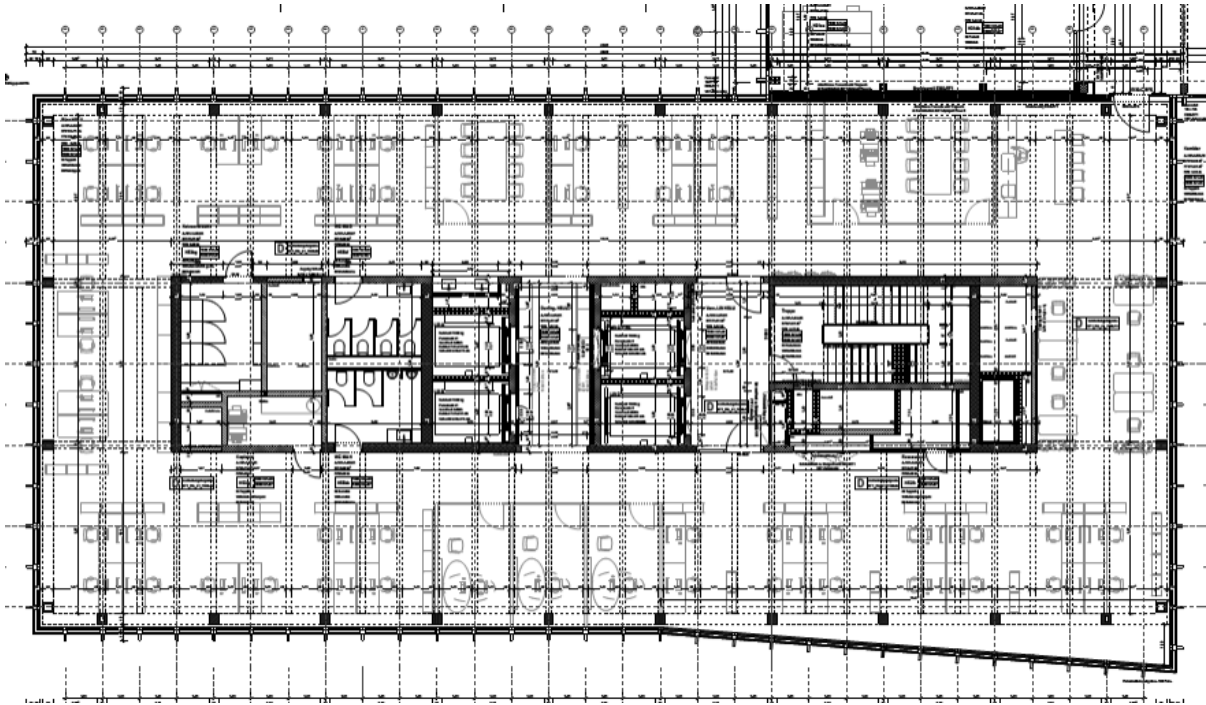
Übersicht zum 60m Hochhaus – Grundriss Architektur 6. Obergeschoss mit dem auskragenden Gebäudeteil auf der Längsseite
